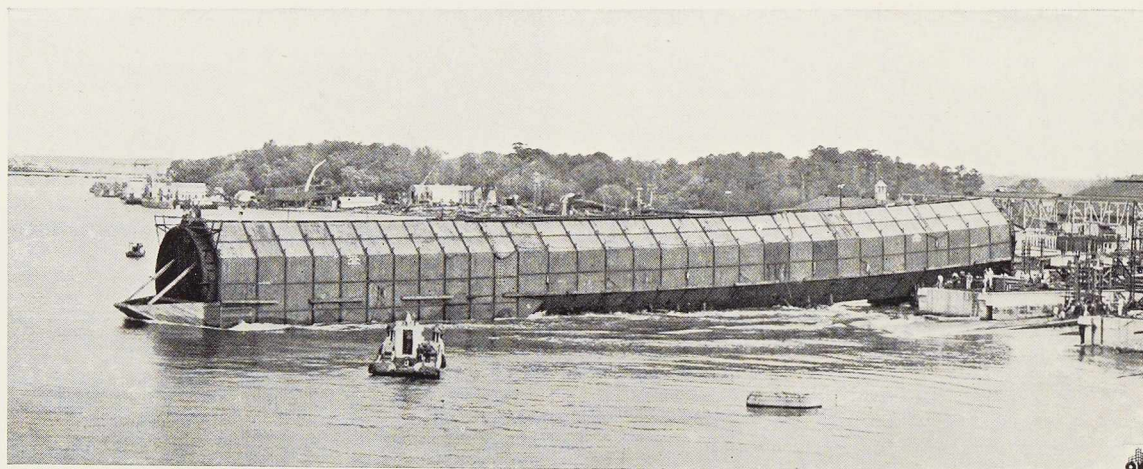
Mise en place du tunnel, lancé à l'eau par glissement.
